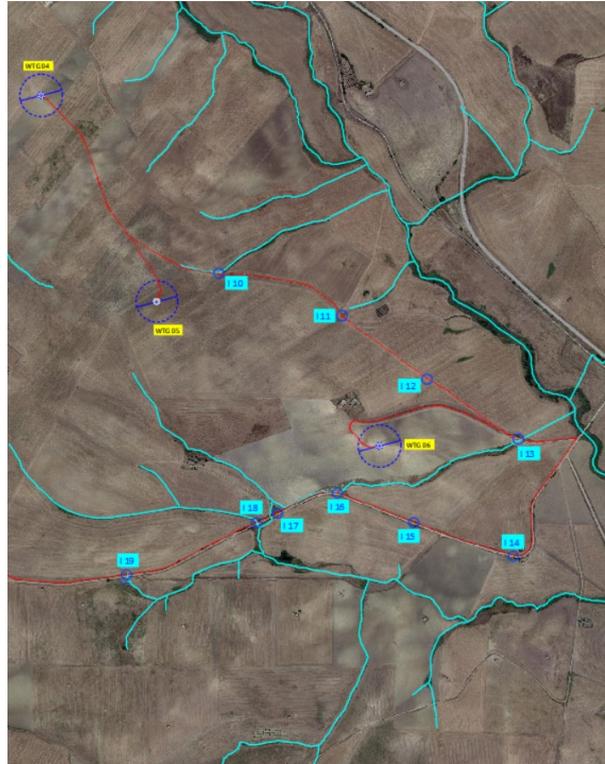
Individuazione planimetrica delle interferenze dalla I10 alla I19 (Rif. EO.IRS01.PD.A.16.a.20.1)
